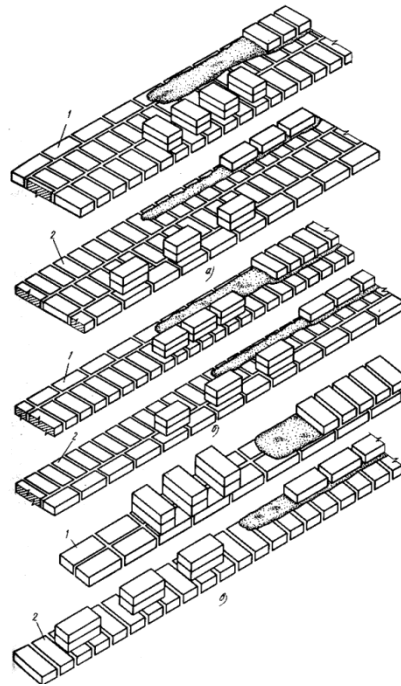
Раскладка кирпича при кладке стен толщиной:
